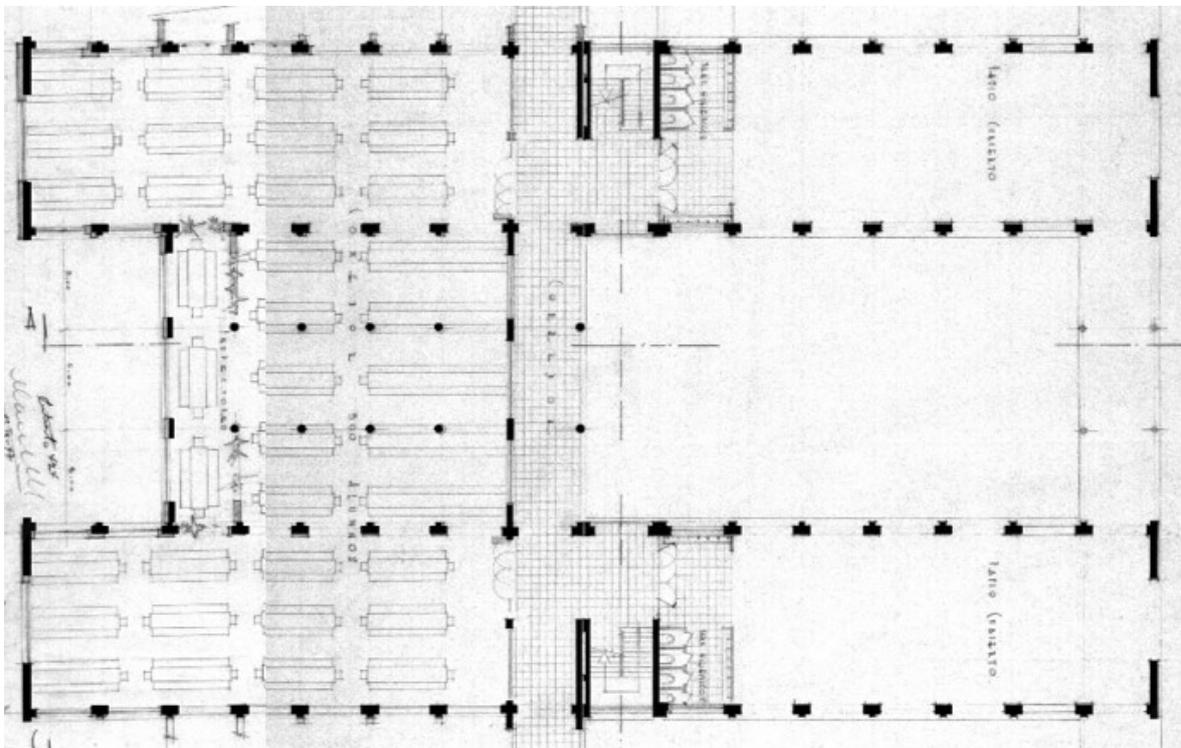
Planta primer nivel Ex internado de 1946. Fuente: Archivo histórico MOP.
